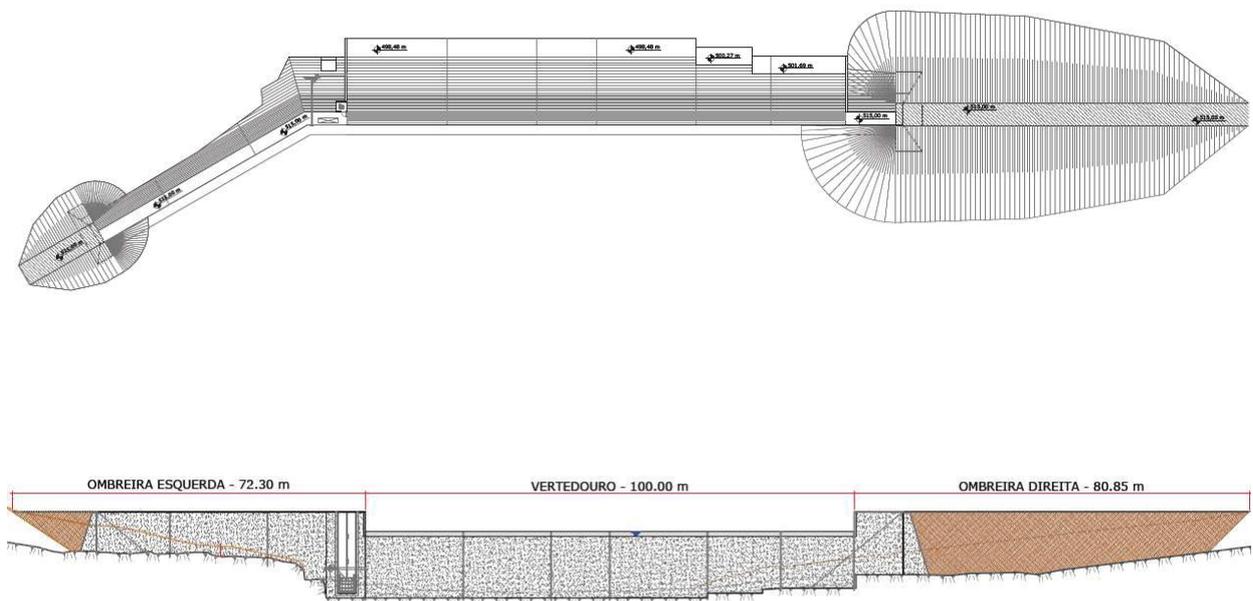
Projeto do Barramento - Planta e Perfil. Fonte: Enebrás
